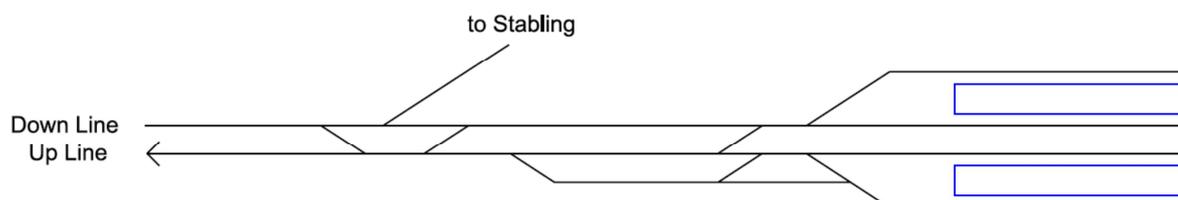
Layout da estação de Campinas (HALCROW-SINERGIA, 2008)
